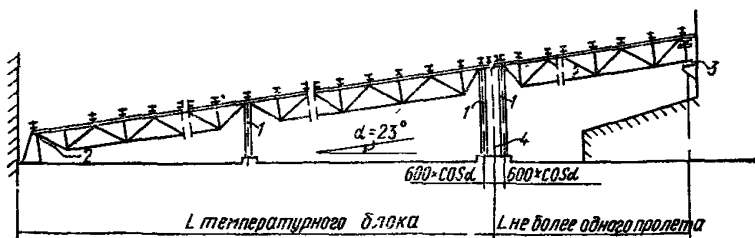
Конструктивная схема галереи с расположением транспортера по верху ферм
